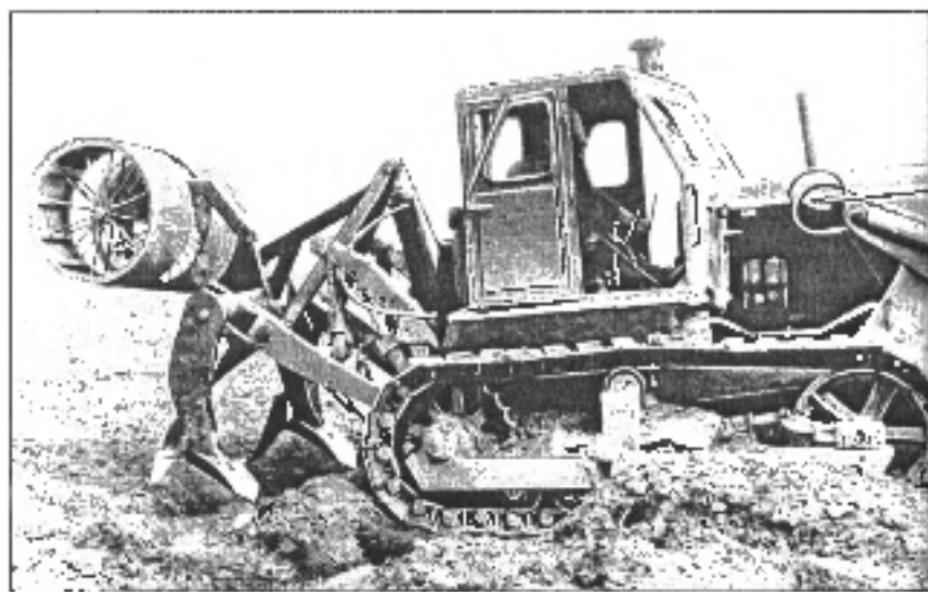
Рыхлитель-кротователь универсальный РУ.65.2,5.
